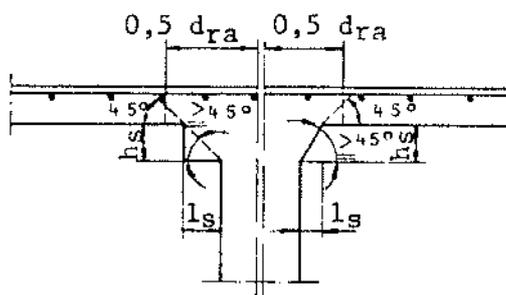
Losa con refuerzo apoyada sobre columna; según párrafo a) con $\ell_s \leq h_s$
